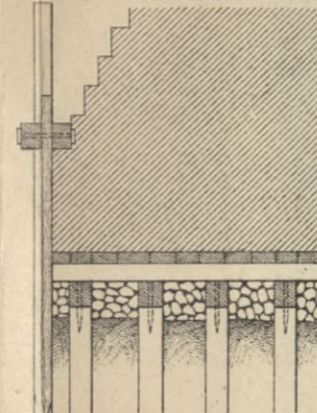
Betonfangdamm als Teil des endgültigen Baues. M. 1:200. A cross-sectional diagram of a concrete retaining wall as part of the final construction.
